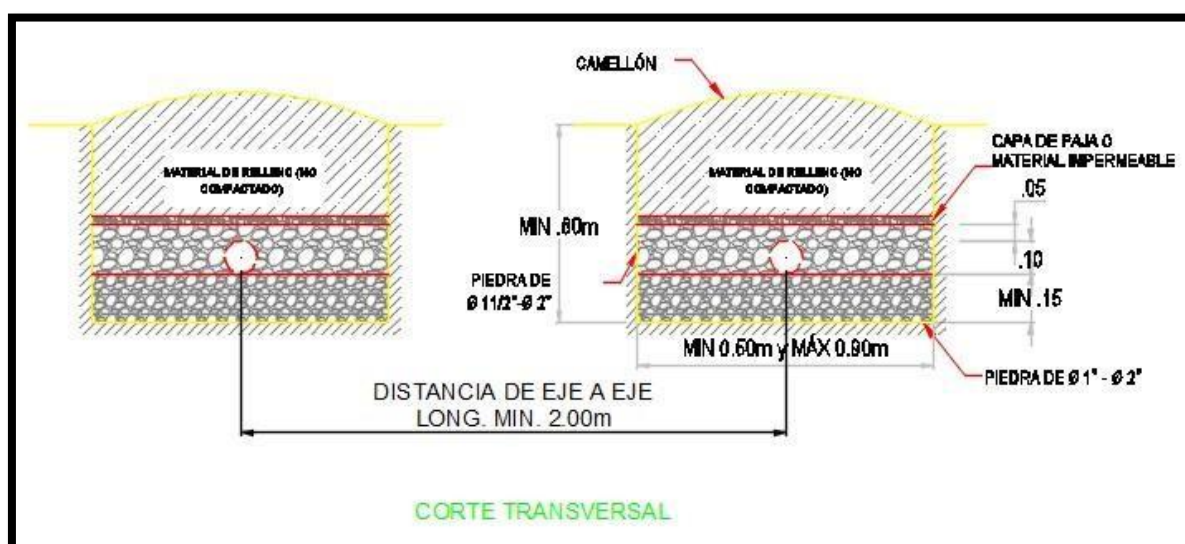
CORTE TRANSVERSAL DE ZANJA DE INFILTRACION
